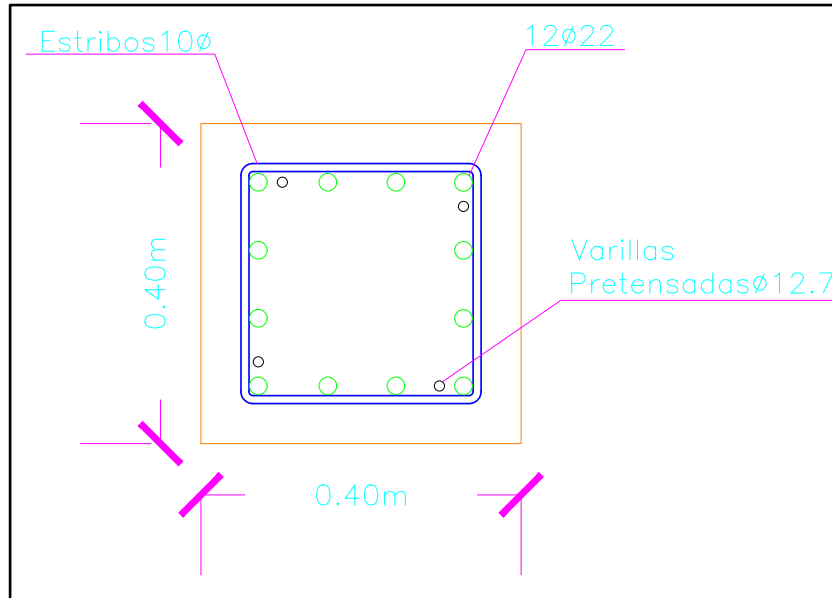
Dimensionamiento del pilote para el muelle principal. Fuente: Autores
